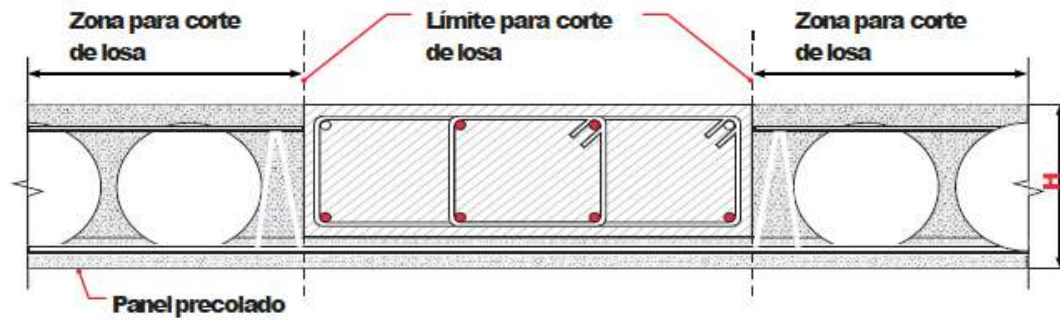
Detalle de zonas de corte en losas BDM
